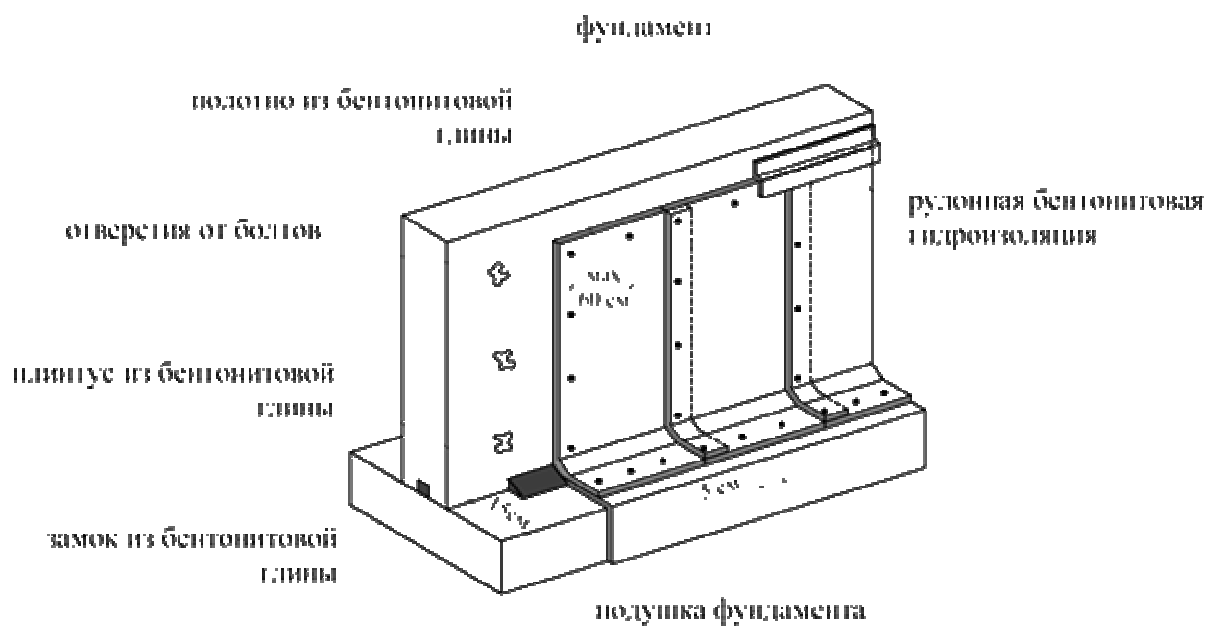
Укладка гидроизоляционных матов на вертикальную поверхность монолитного железобетонного фундамента с креплением верха планкой и бентонитовой шпатлёвкой
